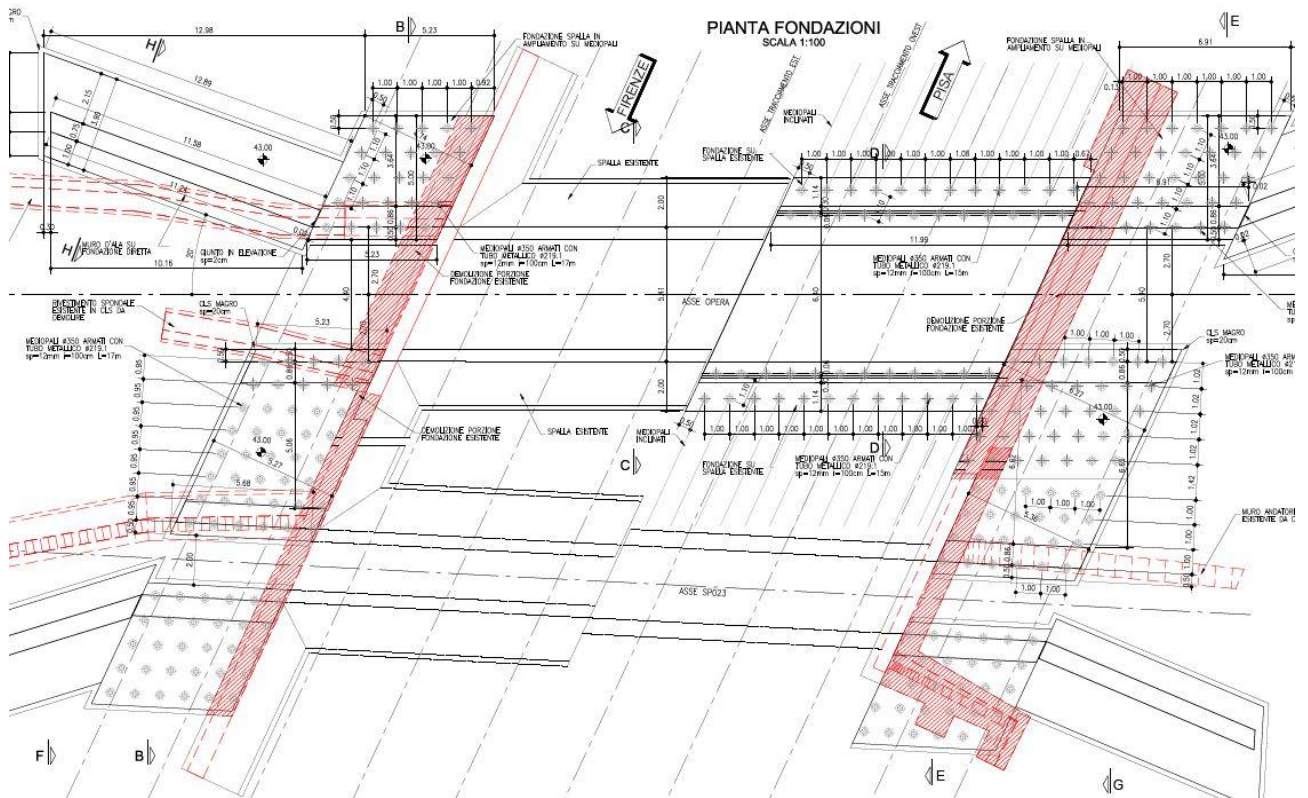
Planimetria di progetto opere di fondazione.
